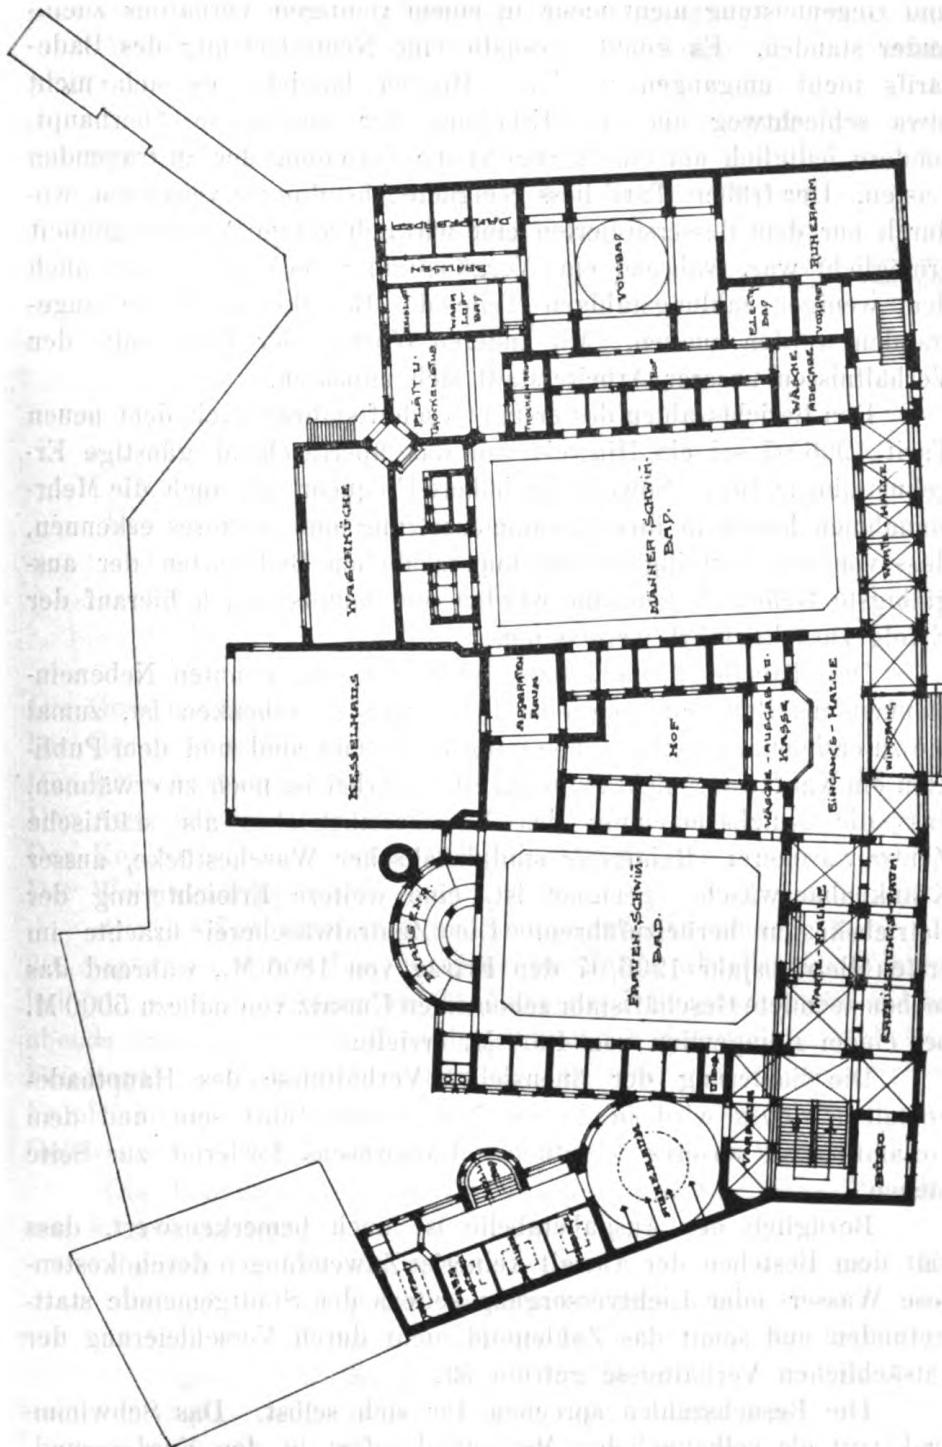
Grundriss mit projektierter Erweiterung.
